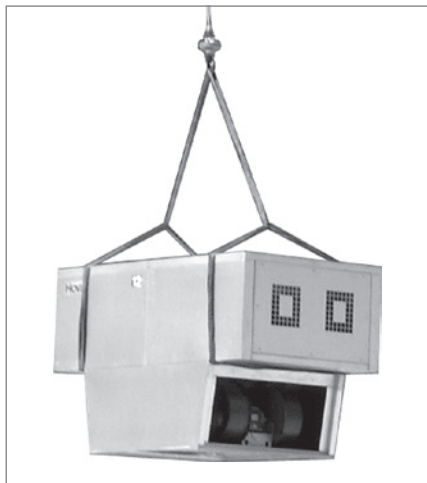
RoofVent® Dachgeräte werden vom Dach aus montiert.
